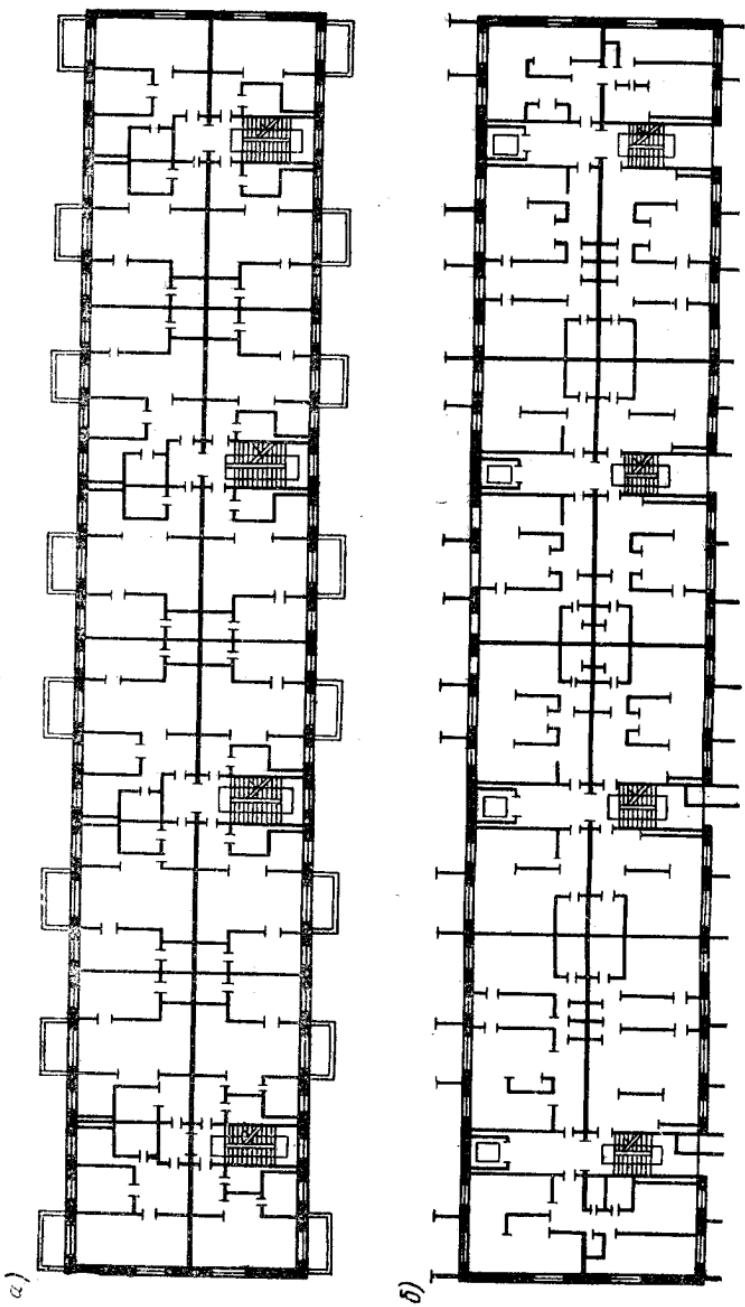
Проект модернизации жилого дома серии 1-515 (Москва). План типового этажа:
